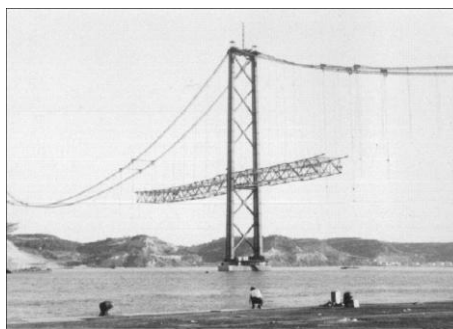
Ponte Salazar em construção 1963 (Actual ponte 25 de Abril).
